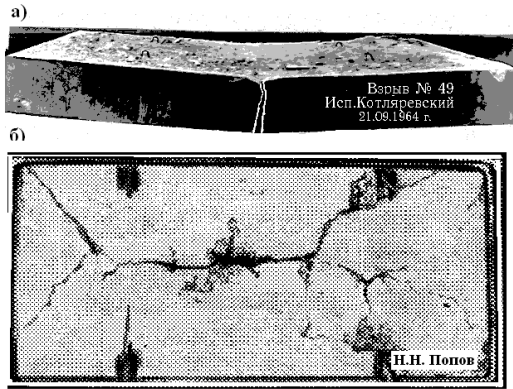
Типичные формы разрушения однопролетных железобетонных конструкций при поперечной взрывной нагрузке: а) свободно опертой балочной плиты с образованием центральной трещины с пластическим шарниром, б) плиты, опертой по контуру, с образованием трещин по схеме «конверт» с линейными пластическими шарнирами
